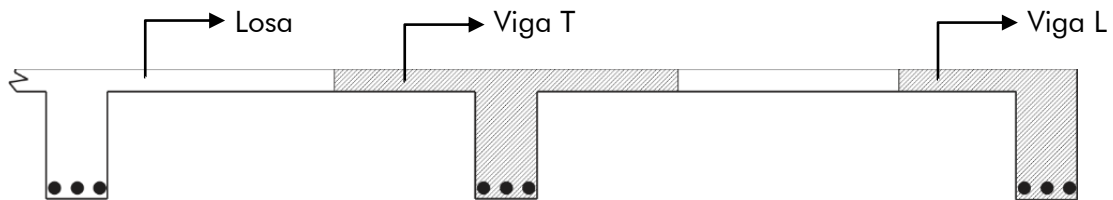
Vigas con colaboración de losa como hormigón comprimido
